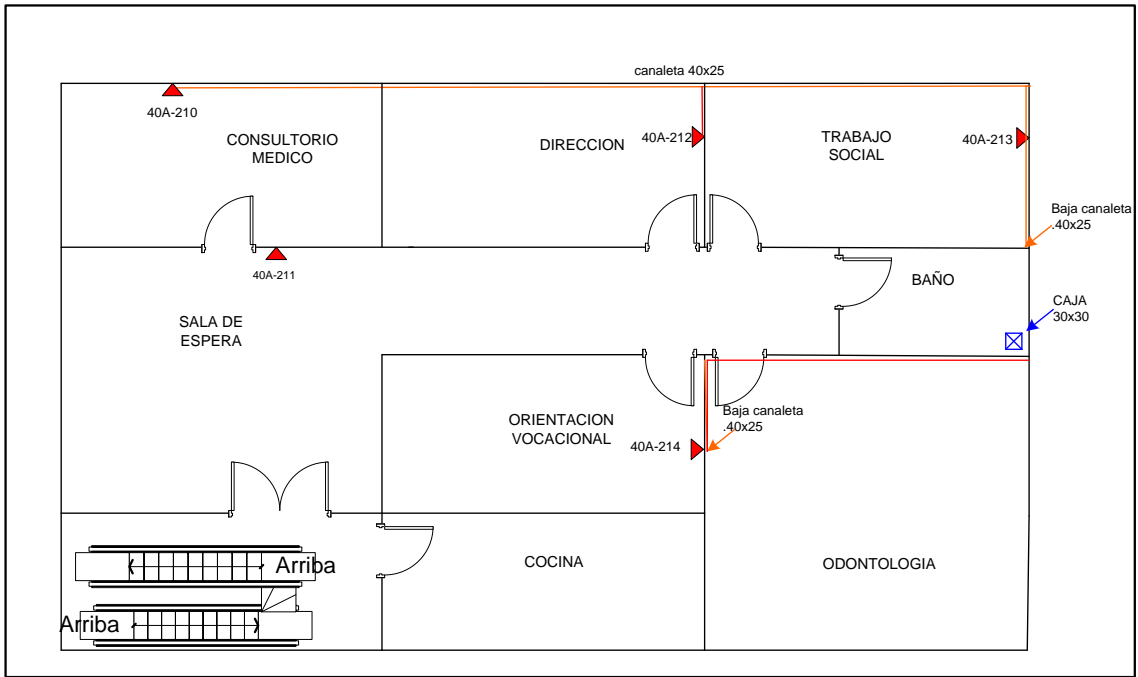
Plano de Comunicación Segunda Planta –Edificio Verde
